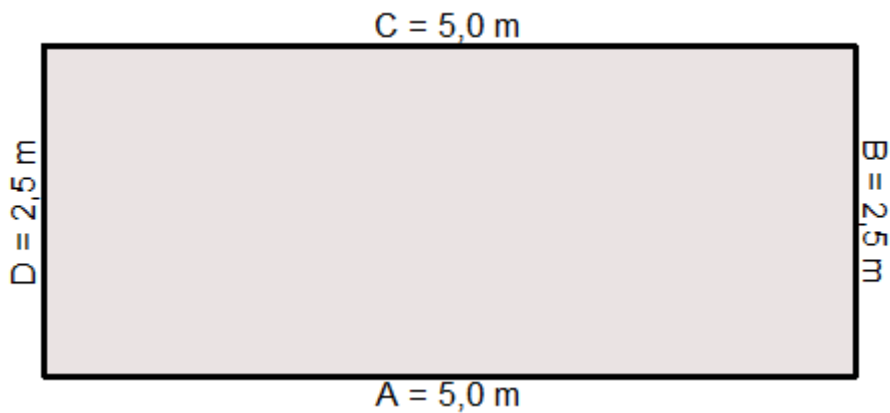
Grundriss TinyHouse (BGF)
